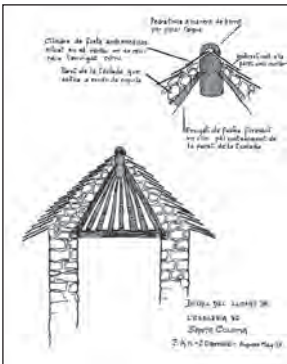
Detall del llosat de l'església de Santa Coloma (PAN - Pere Canturri, maig 1979)
